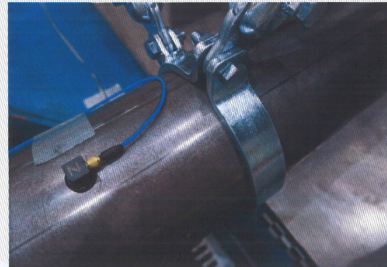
시험 후 UUT-2 흔들림방지버팀대(근접)
